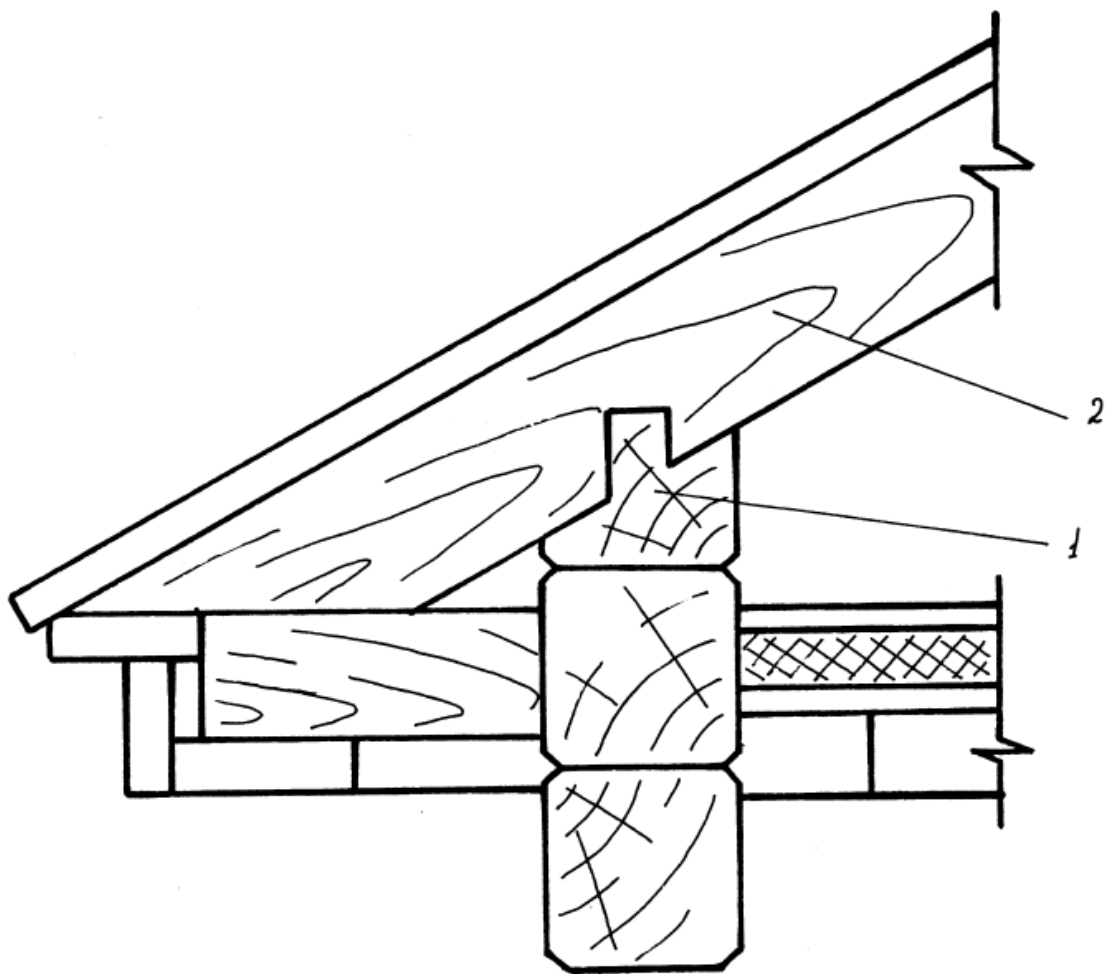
Наслонные стропила: 1 – стропильная нога; 2 – ригель; 3 – чердачное перекрытие.
